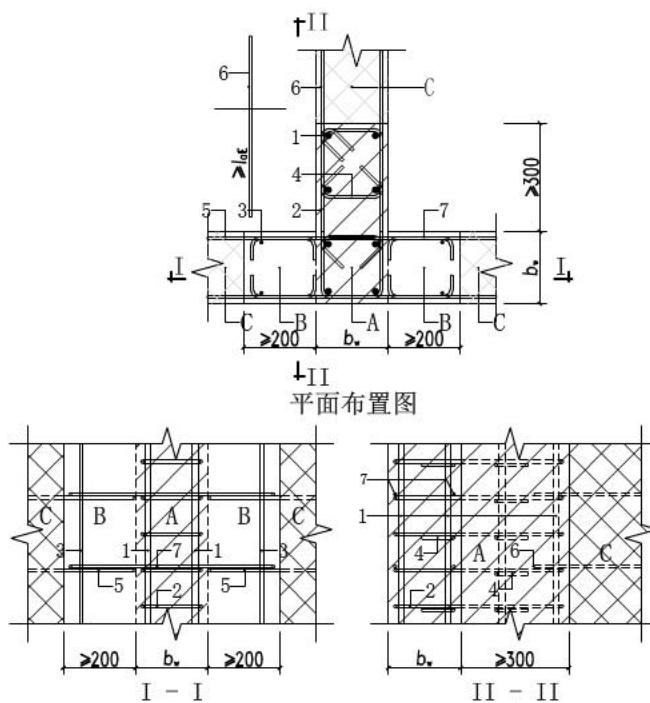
预制墙板水平钢筋连接、锚固构造示意
